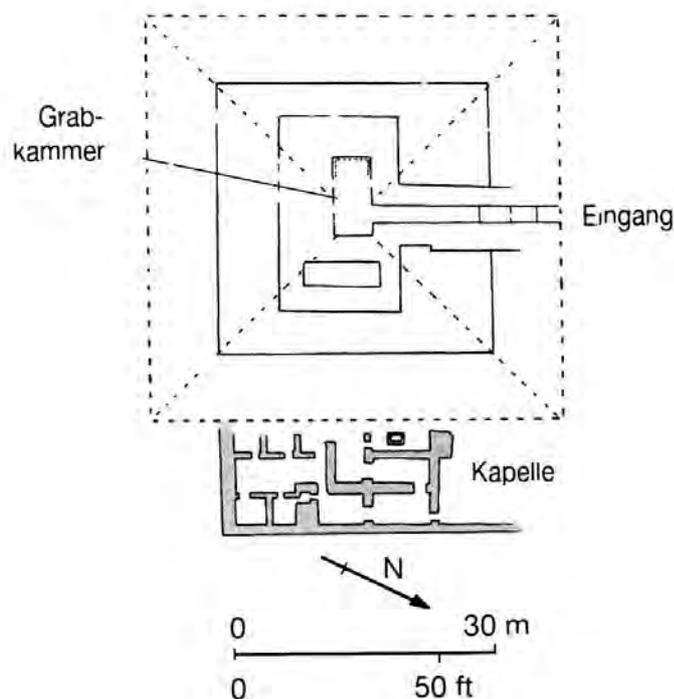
Grundriss der Pyramide des Ibi
